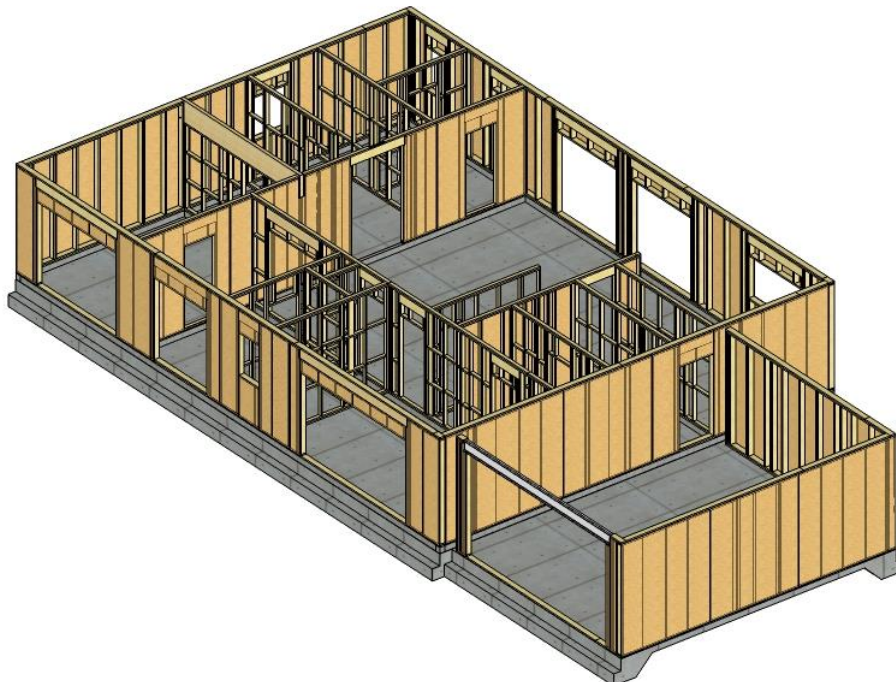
Piso térreo de uma estrutura ainda sem cobertura, em *Timber Frame
